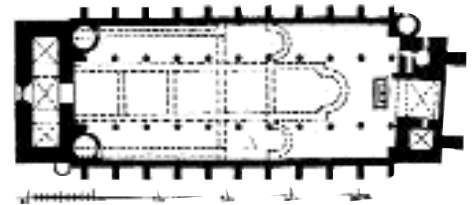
Halle, Marktkirche, ausgeführter Grundriß über dem Grundriß der Gertrudenkirche (schraffiert), 1555
